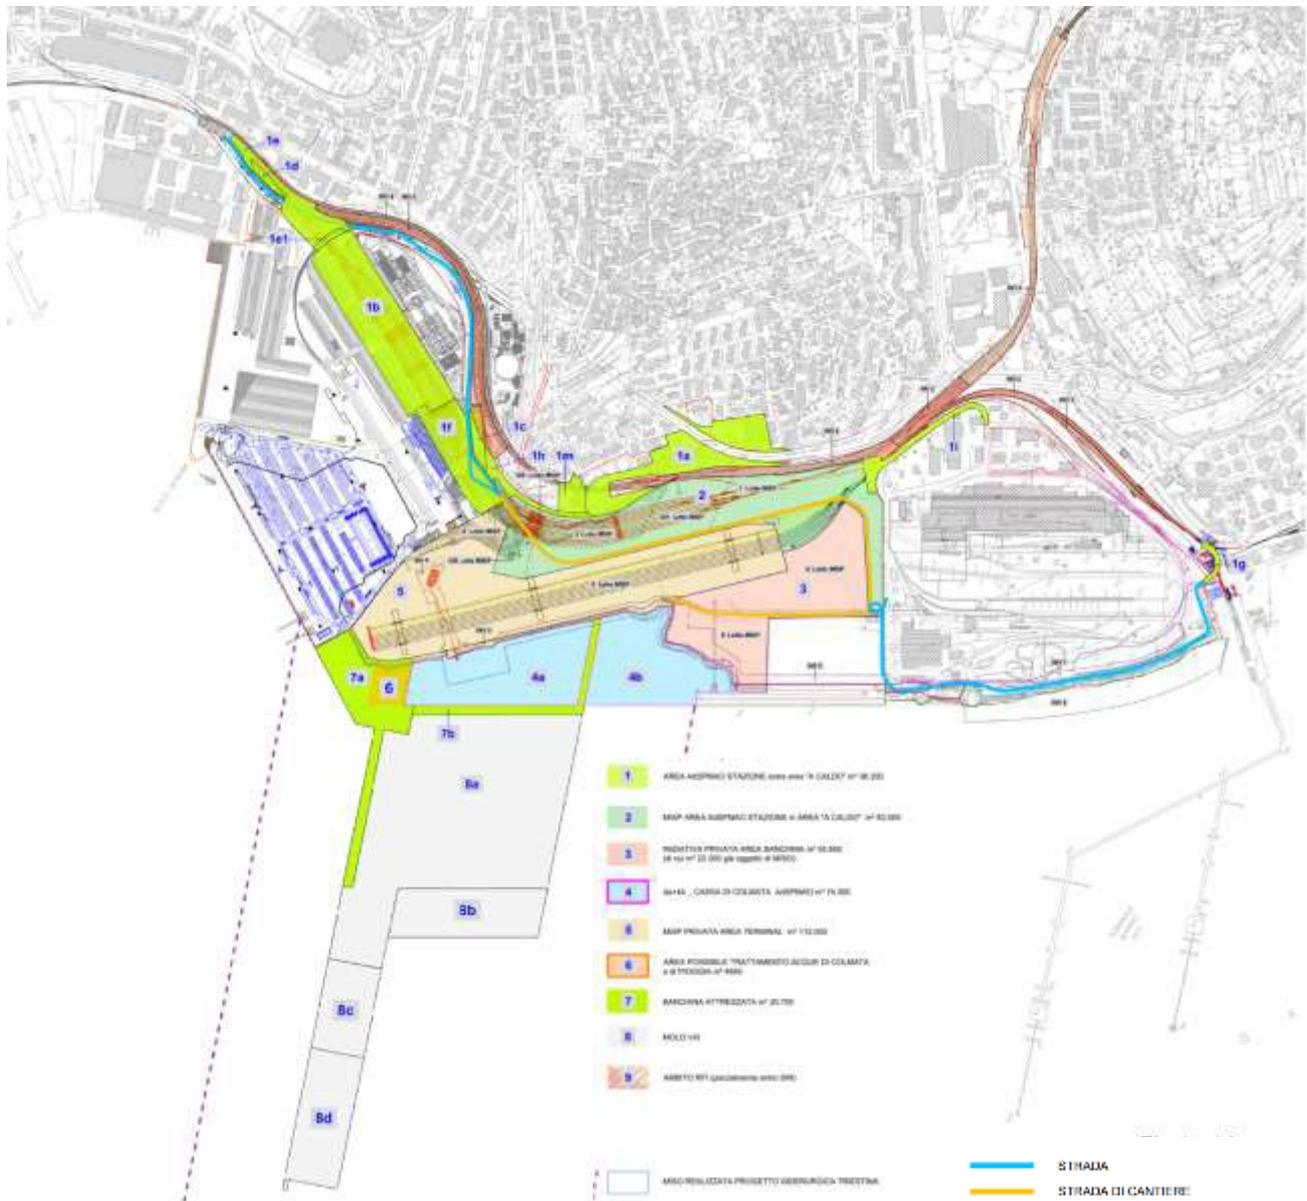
estratto dell'allegato 4.26 - individuazione delle aree di cantiere, con indicati gli accessi nei momenti di sovrapposizione delle varie opere
